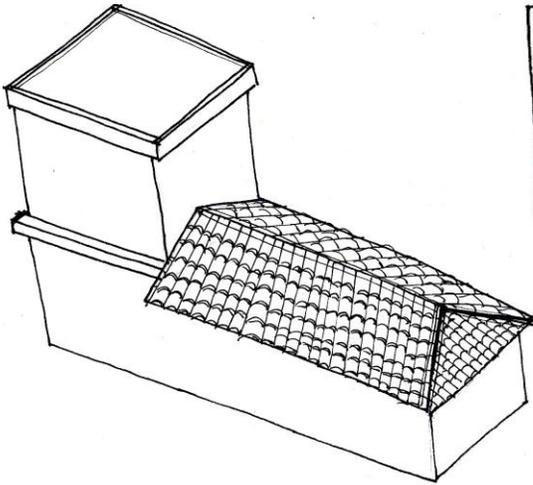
Se pierden elementos como la quinta fachada integrada a su entorno original, ya que se adiciona una losa de concreto plana. Elaboró: Mauricio
